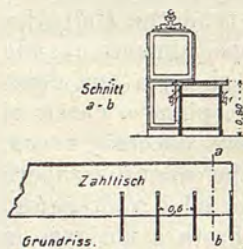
Banco per impiegati e pubblico. *Schnitt a-b*, sezione a-b; *Grundriss*, pianta; *Zahlisch*, banco.
